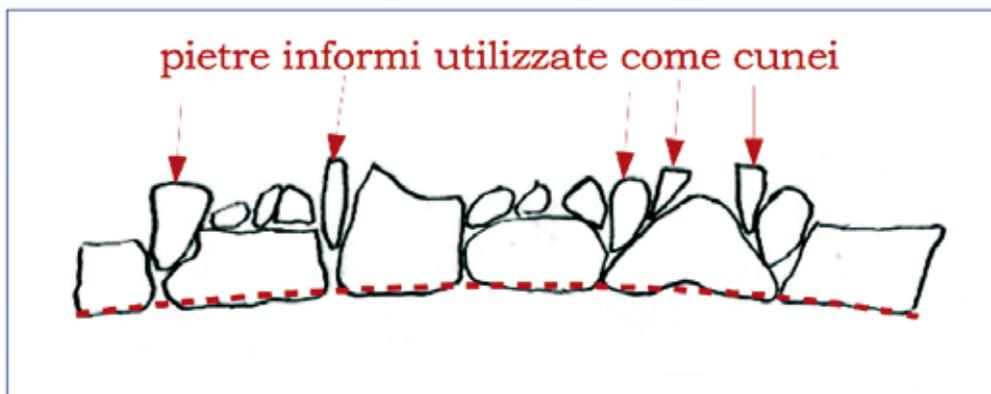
Schizzo planimetrico del filare di pietre costituenti la base del muro, con l'inzeppamento di pietre all'interno. Il tratteggio rappresenta la "linea ideale".
